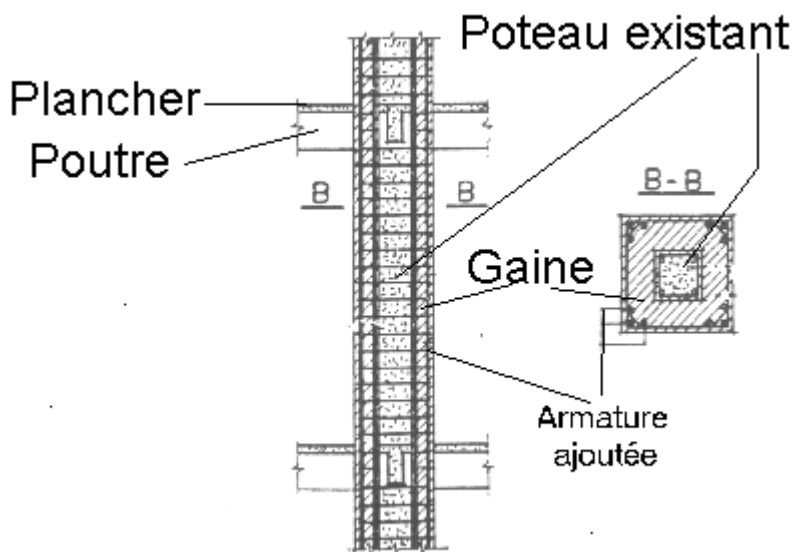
Gainage d'un poteau rectangulaire [6]
